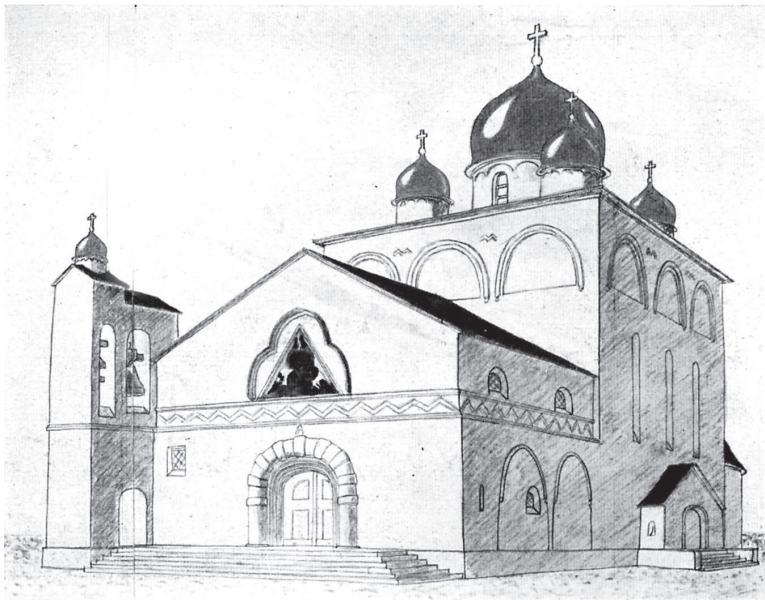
Arch. Edgar Norwerth. Projekt cerkwi murowanej. Polecony do zakupu. Elewacja zachodnia.
